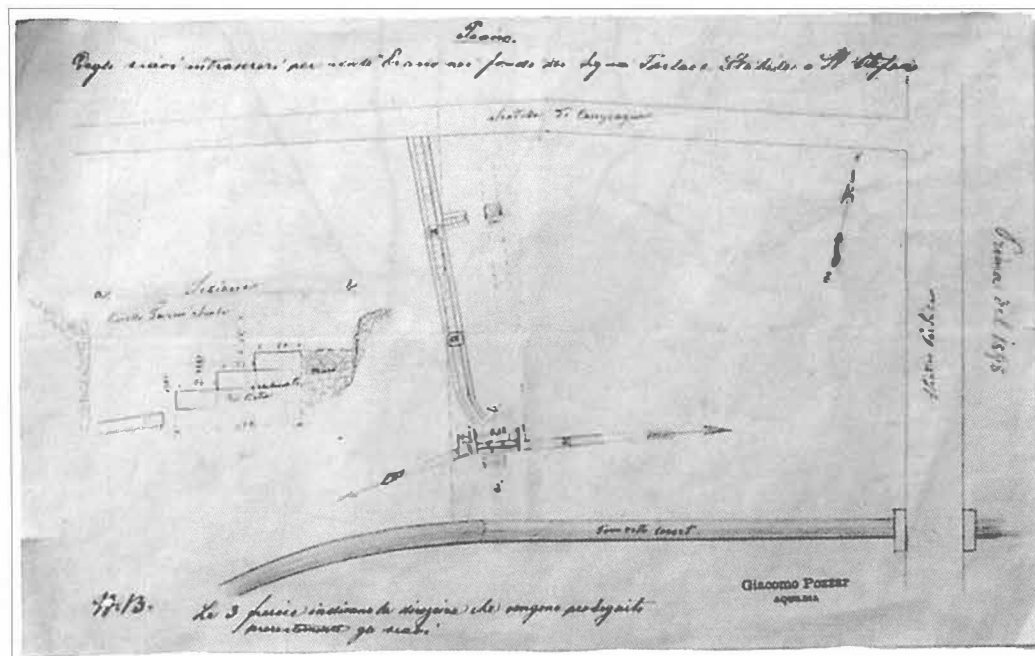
Pianta del banchinamento in località Santo Stefano (G. Pozzar, archivio MAN).
